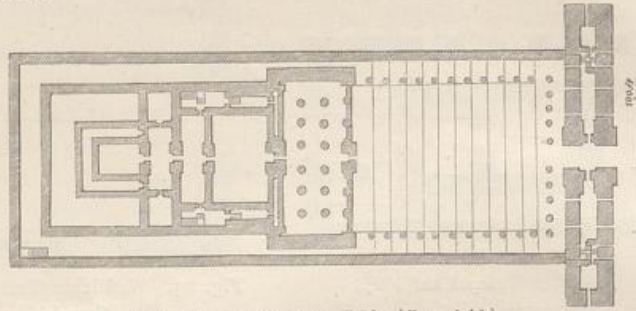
Tempel zu Edfu (Grundriss).
